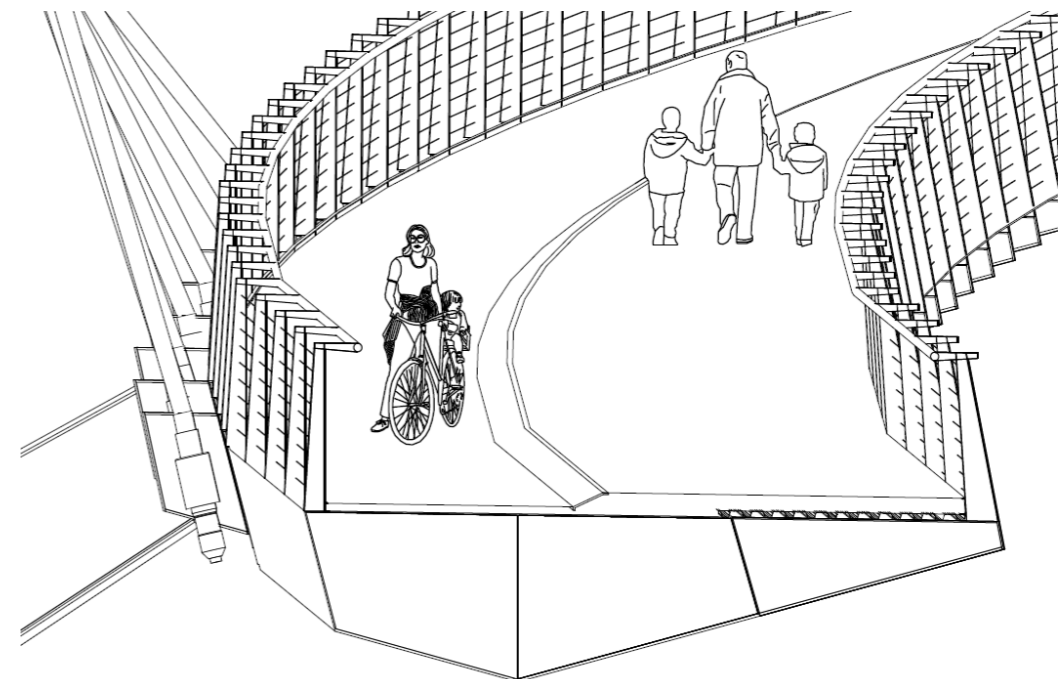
Vista 3D de la pasarela en servicio con secciones de atirantamiento. Fuente: Elaboración Propia (AutoCAD)
